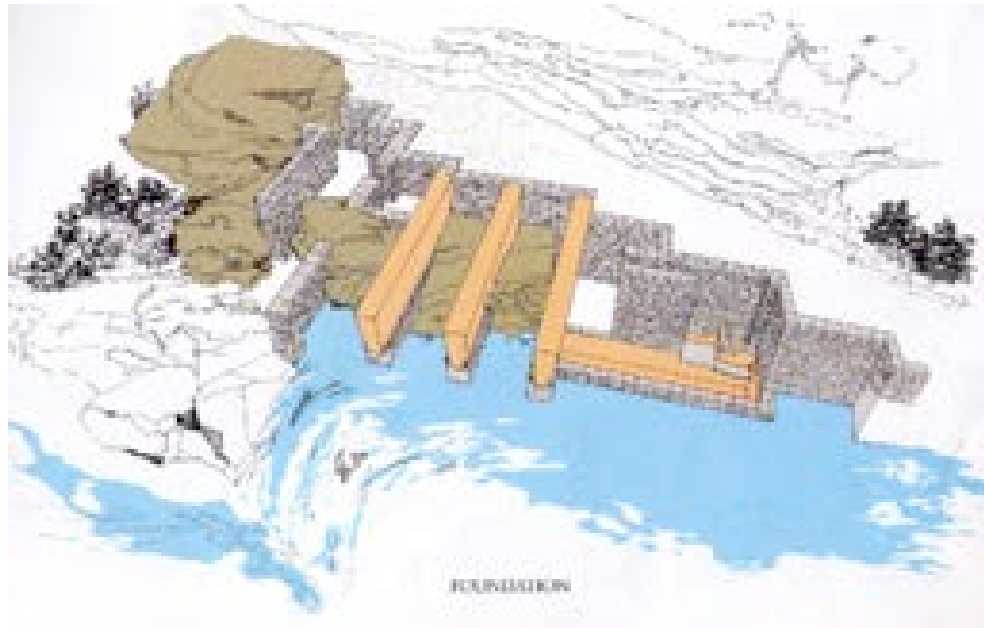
Le fondazioni della Fallingwater ¹⁴⁹
